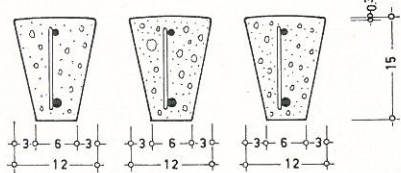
Distanzkeile bei Betonbalken. (Photo: ILB publikatie, Wageningen 11/1961.)
